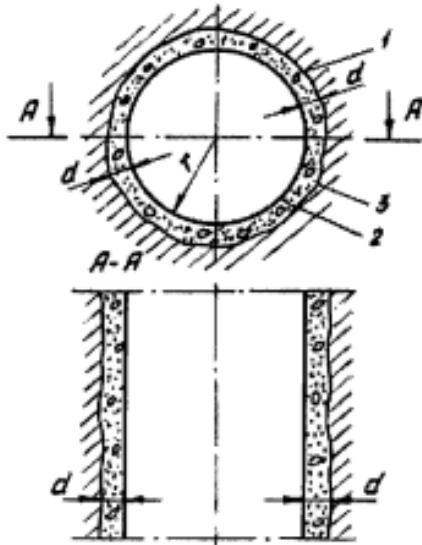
Монолитная бетонная крепь шахтного ствола
